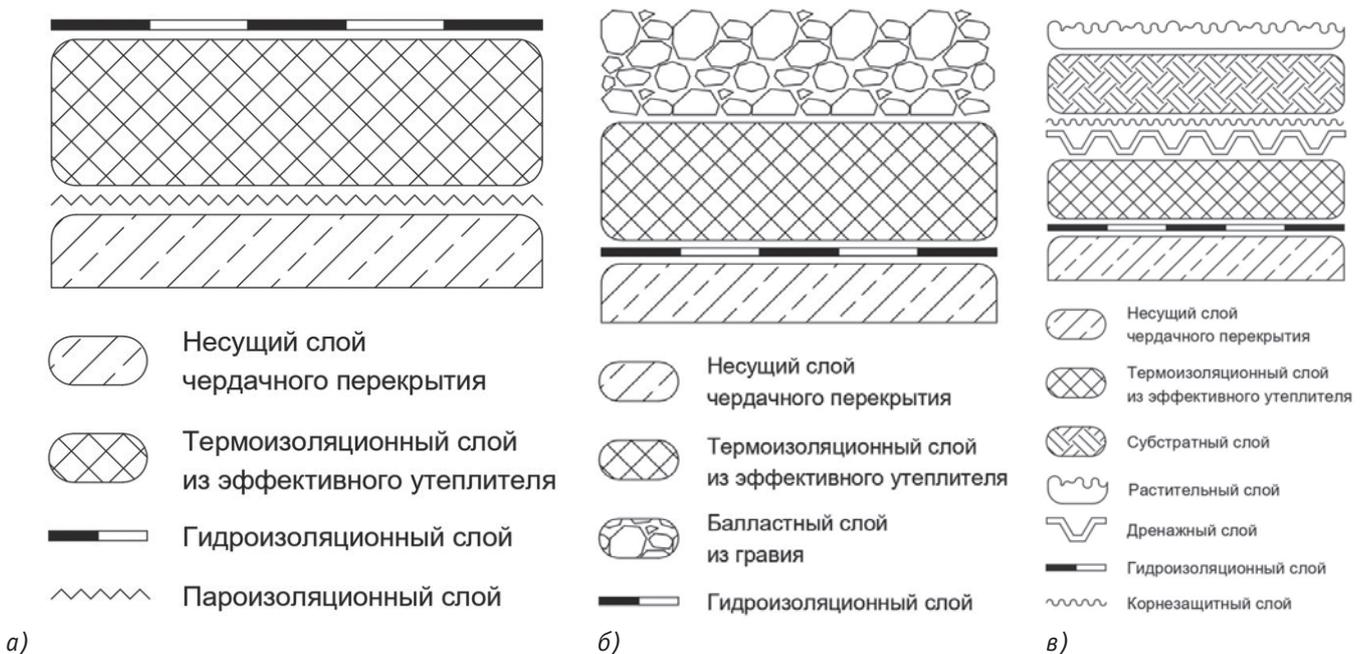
Схема расположения основных слоёв кровельного пирога (источник: [2]): а) стандартной кровли; б) инверсионной кровли; в) озелененной кровли
